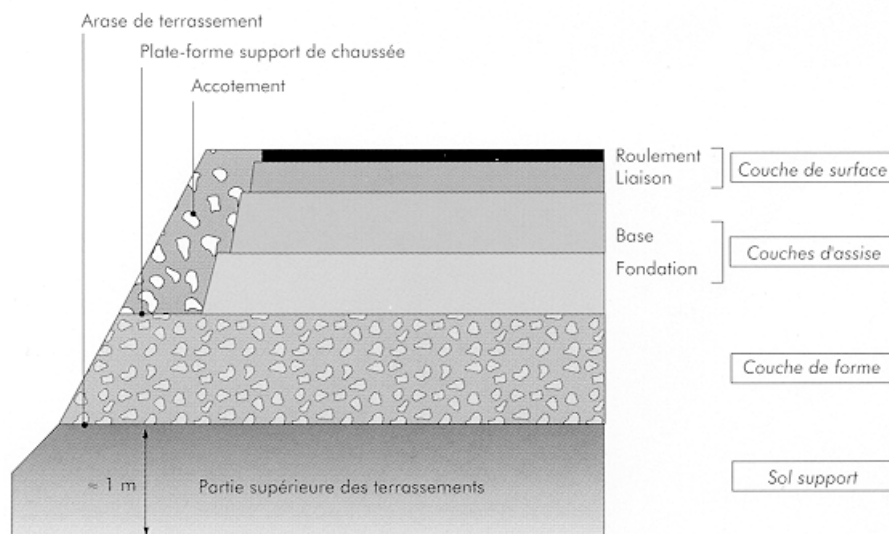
Schéma d'une coupe de chaussée [Guide technique, 1994]
